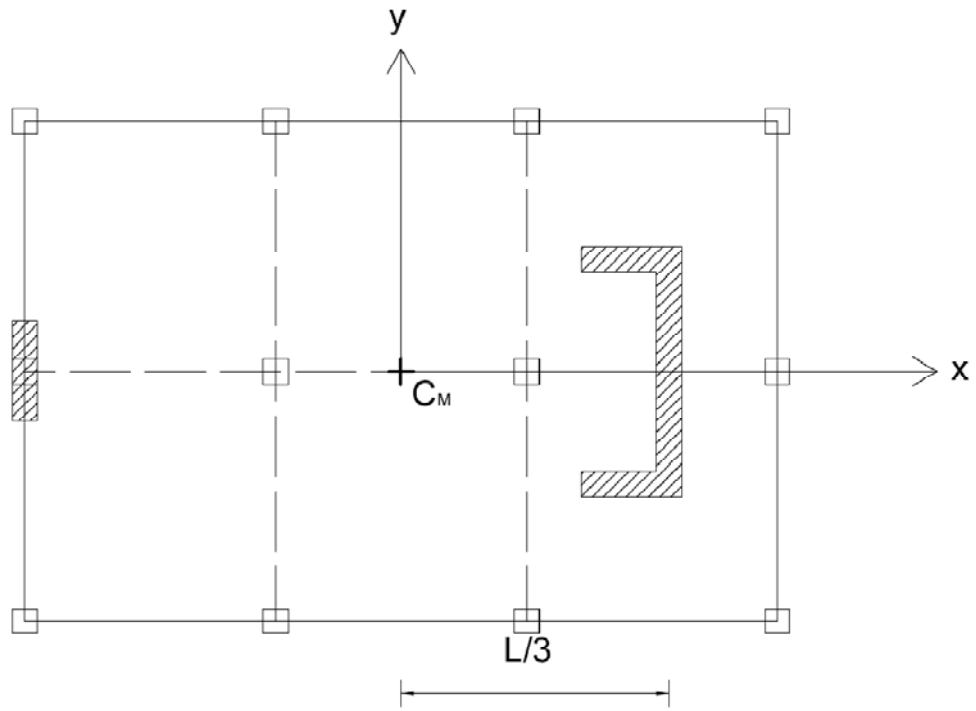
Pianta con setto e vano a C ad  $L/2$  dal baricentro
